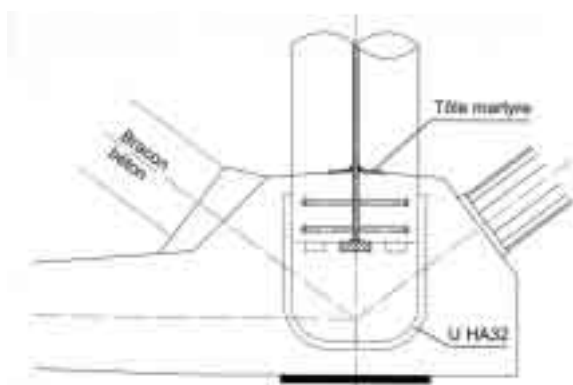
principe de la connexion inférieure (coupe courante sur panneau plan)
